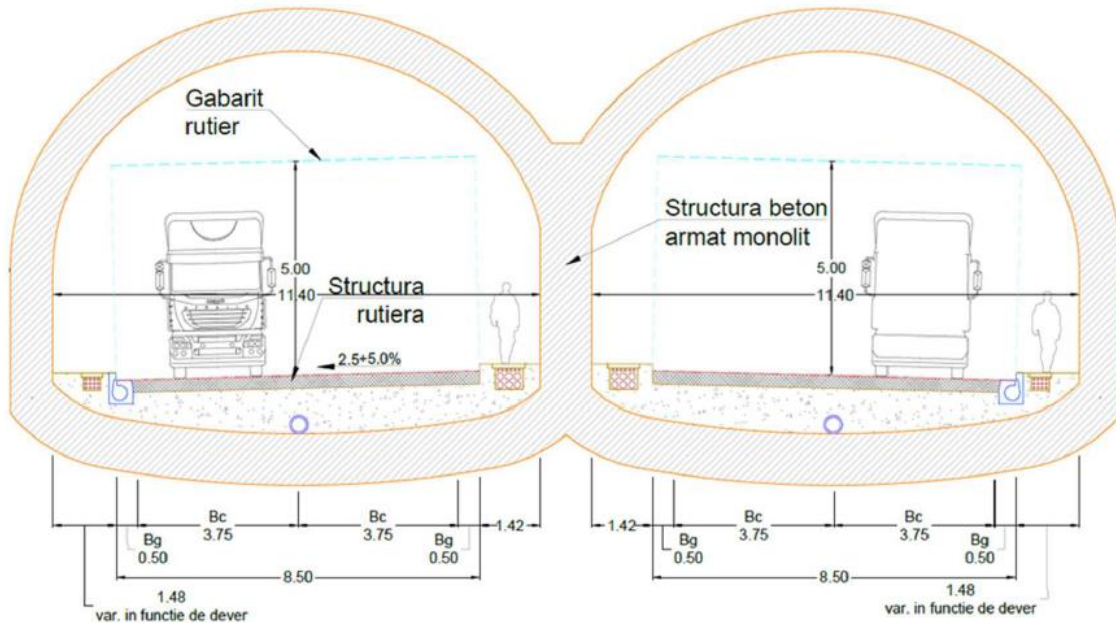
Secțiune transversală Tunel Artificial tip boltă – 2 benzi/sens (PTT02)
